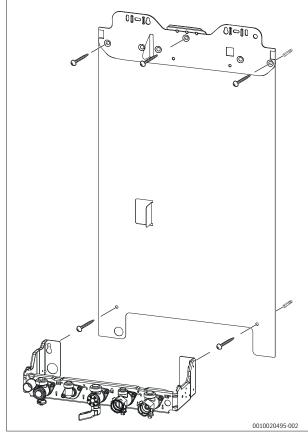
Montage de la plaque de fixation et de la plaque de montage pour le raccordement
